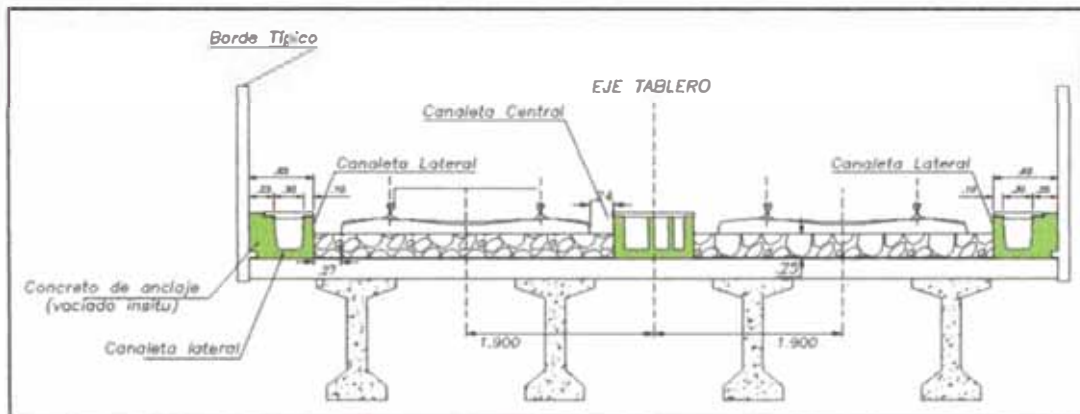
Ubicación de las canaletas en el Viaducto
